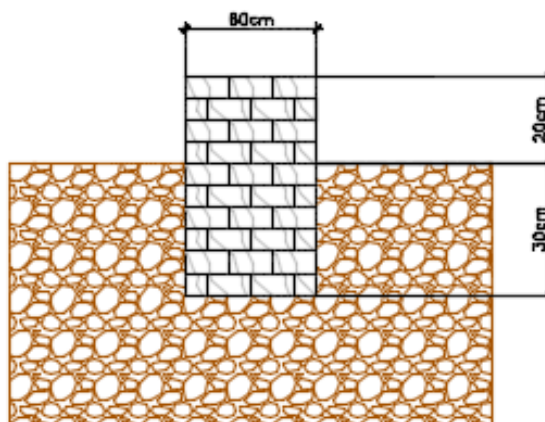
Semelle (Dessin Autocad: SAADAOUI Benaceur OUAHAB Yamina).
